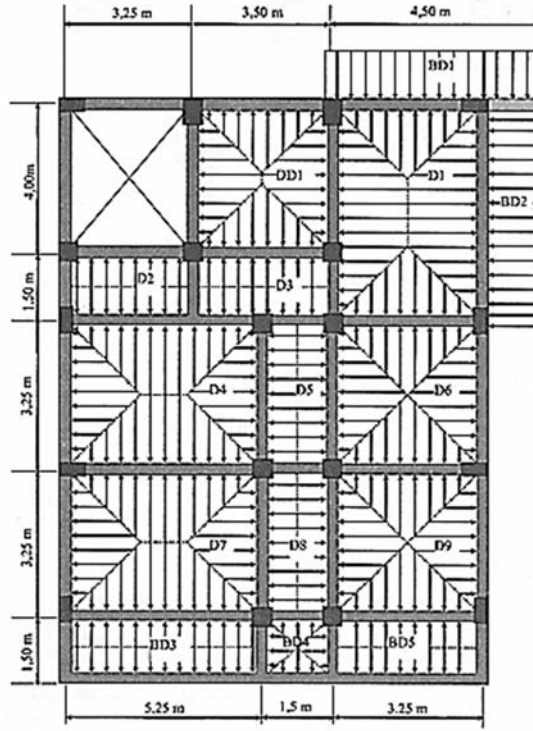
Uygulamada döşemelerden kirişlere yük aktarımında kullanılan yaklaşım.
